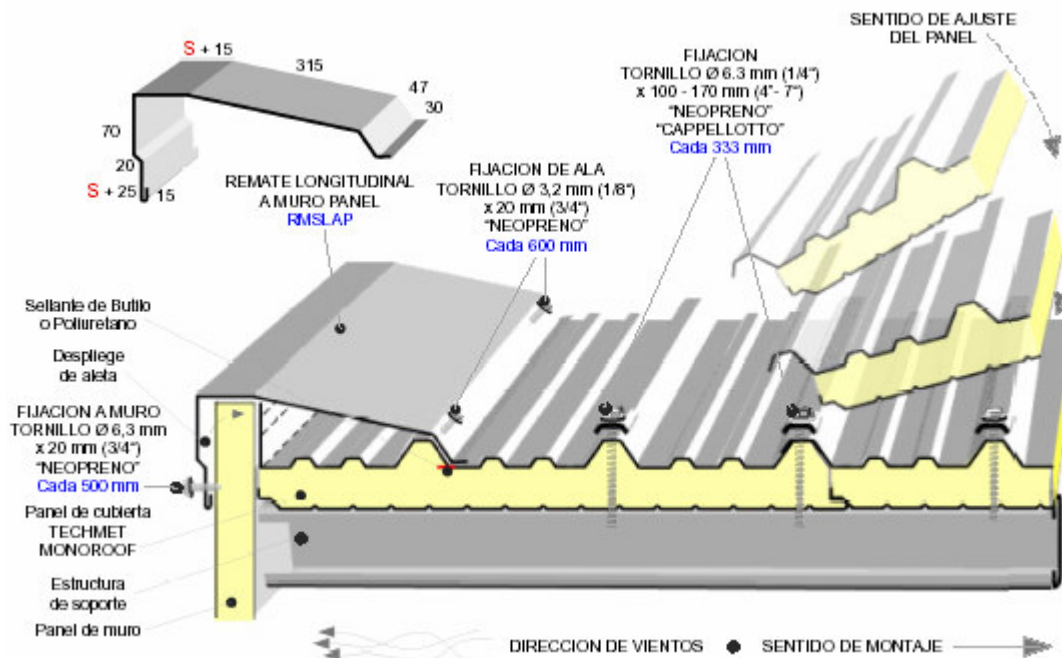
Esquema instalación accesorios de remate longitudinal entre cubierta y muro¹
